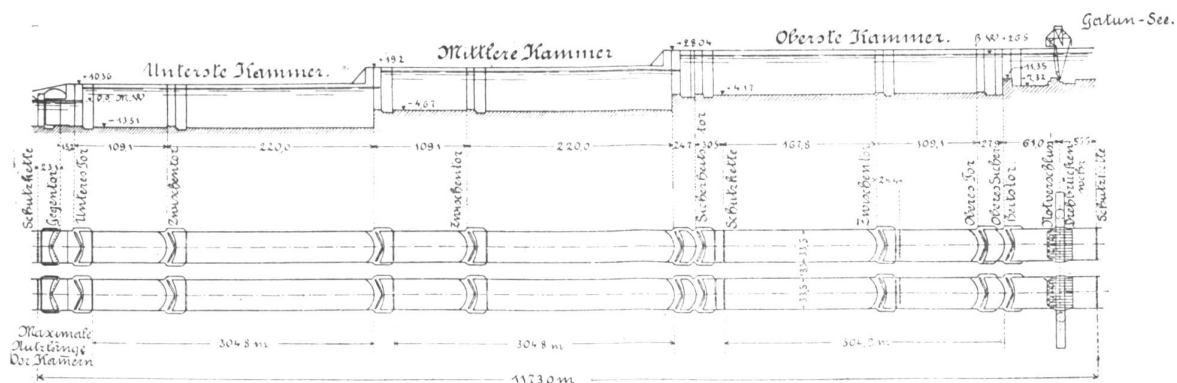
Grundriss und Längsschnitt der dreistufigen Doppelschleusentreppe bei „Gatun“.
